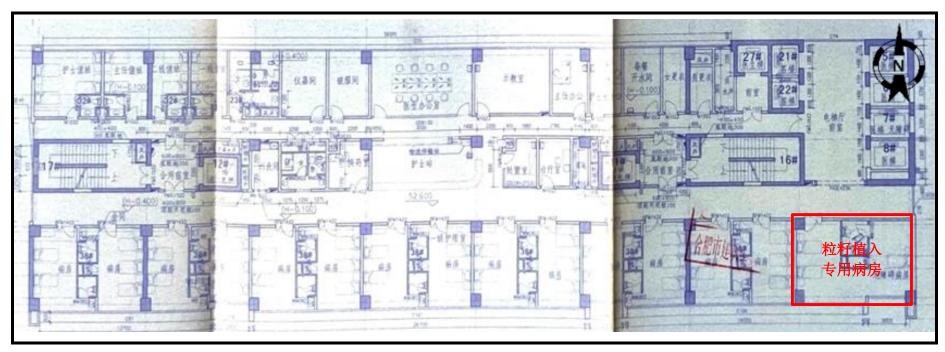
本次竣工环保验收项目粒籽植入专用病房(住院楼十三楼)平面布置示意图
